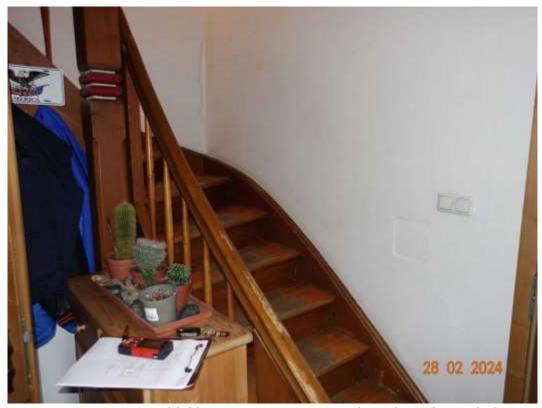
Treppe zum Dachgeschoss des Wohnhauses
